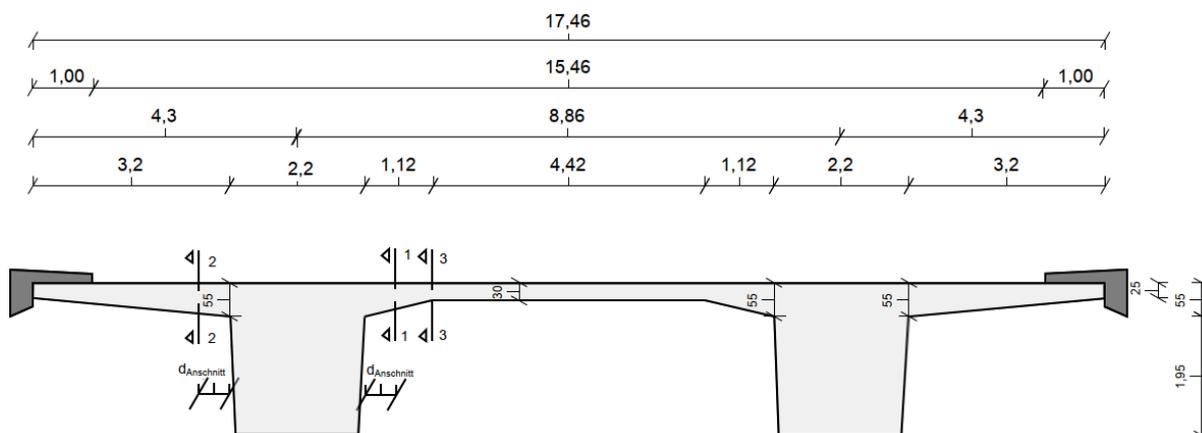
Abmessungen Plattenbalkenquerschnitt, Darstellung der zu untersuchenden Nachweisschnitte
